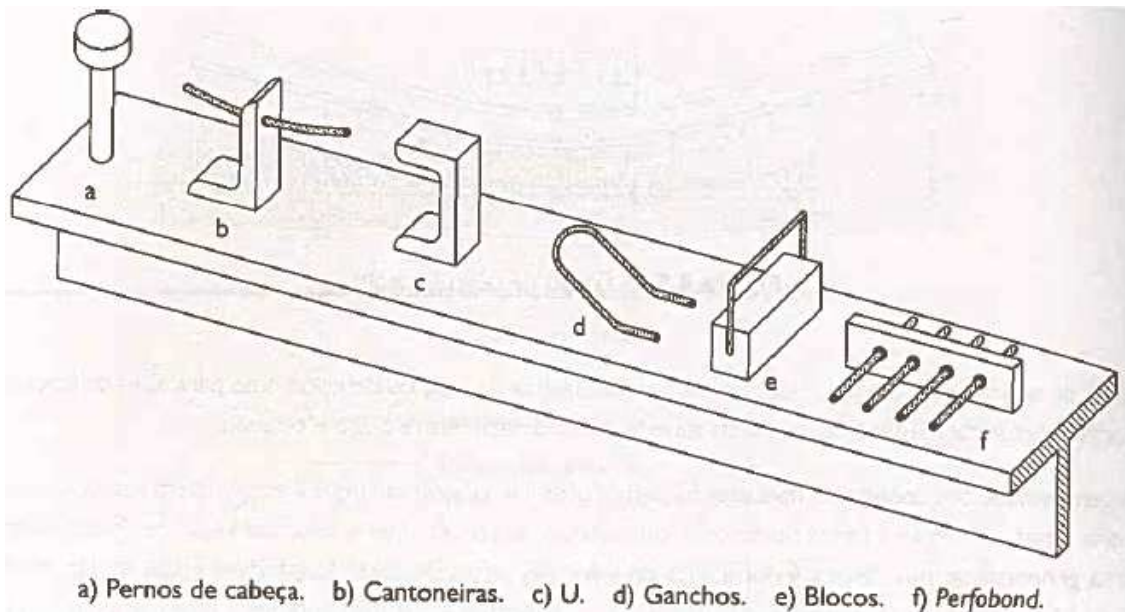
Conectores de corte soldados (adaptado de [4])
